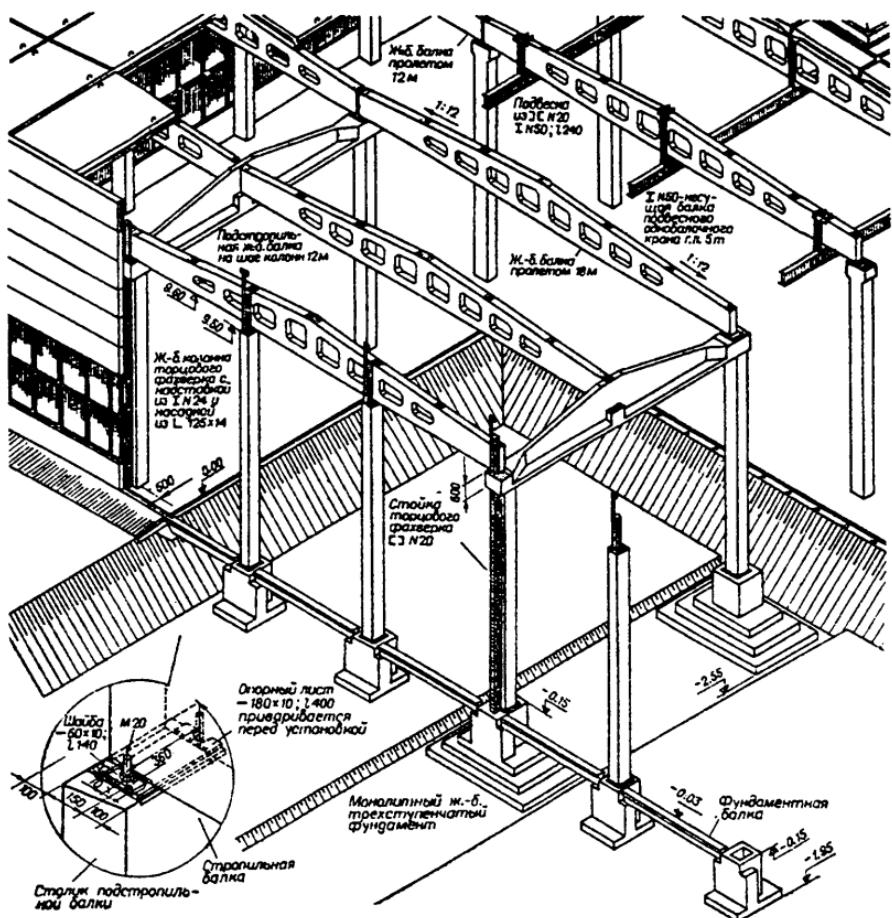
Конструктивные элементы одноэтажного здания с железобетонным каркасом
